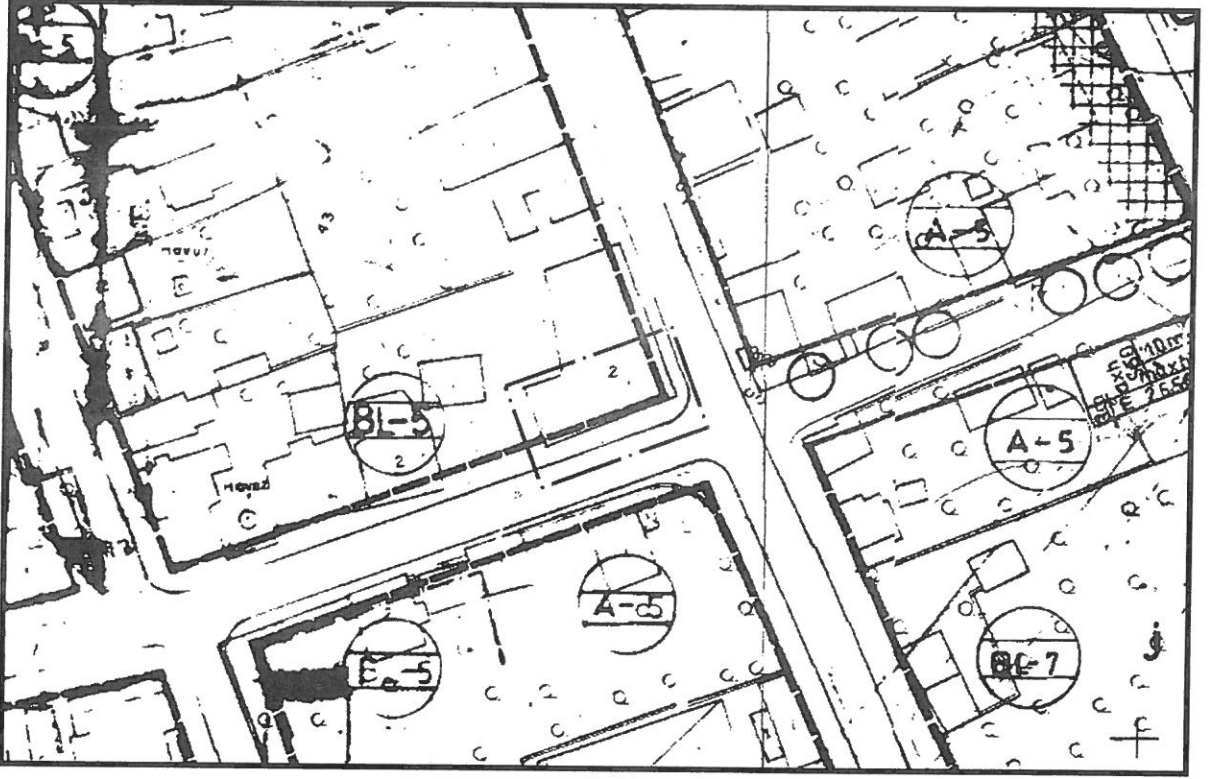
31.5.1966 tarihli onaylanan vaziyet planı
